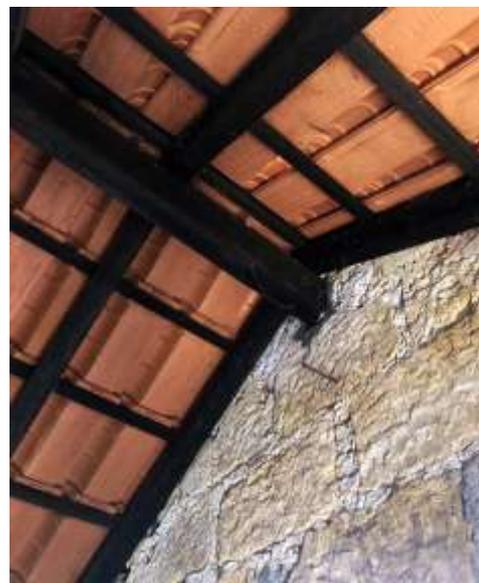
Cobertura com estrutura assente na pedra. (Ilustração nossa, 2021)
